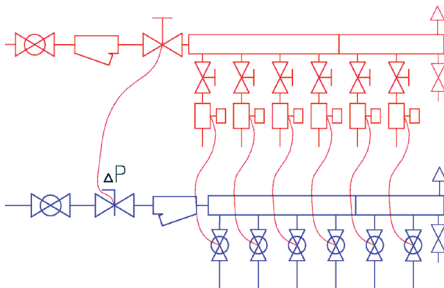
Принципиальная схема поэтажного коллектора с теплосчетчиком на подающем трубопроводе
